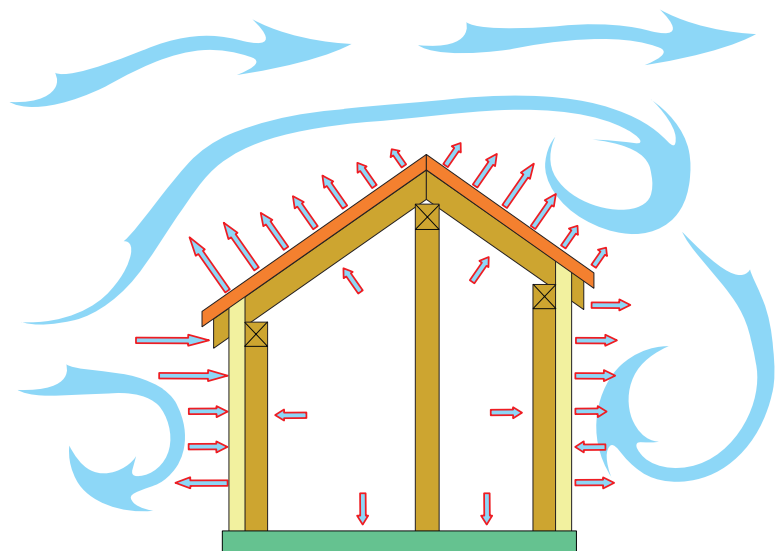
/217: Einwirkung kurzfristiger Lasten; Druck und Unterdruck am geschlossenen Gebäude im Windeinfluss
